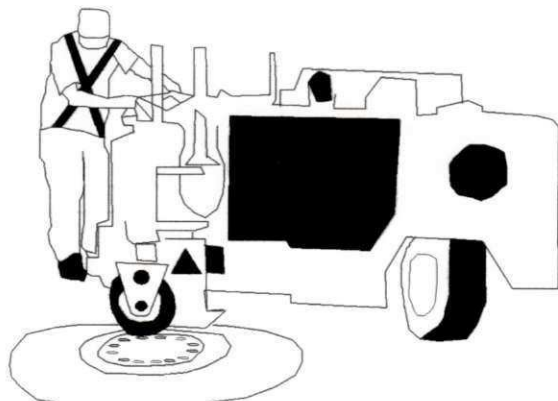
Fresagem de arremate ao redor do tampão de ferro
